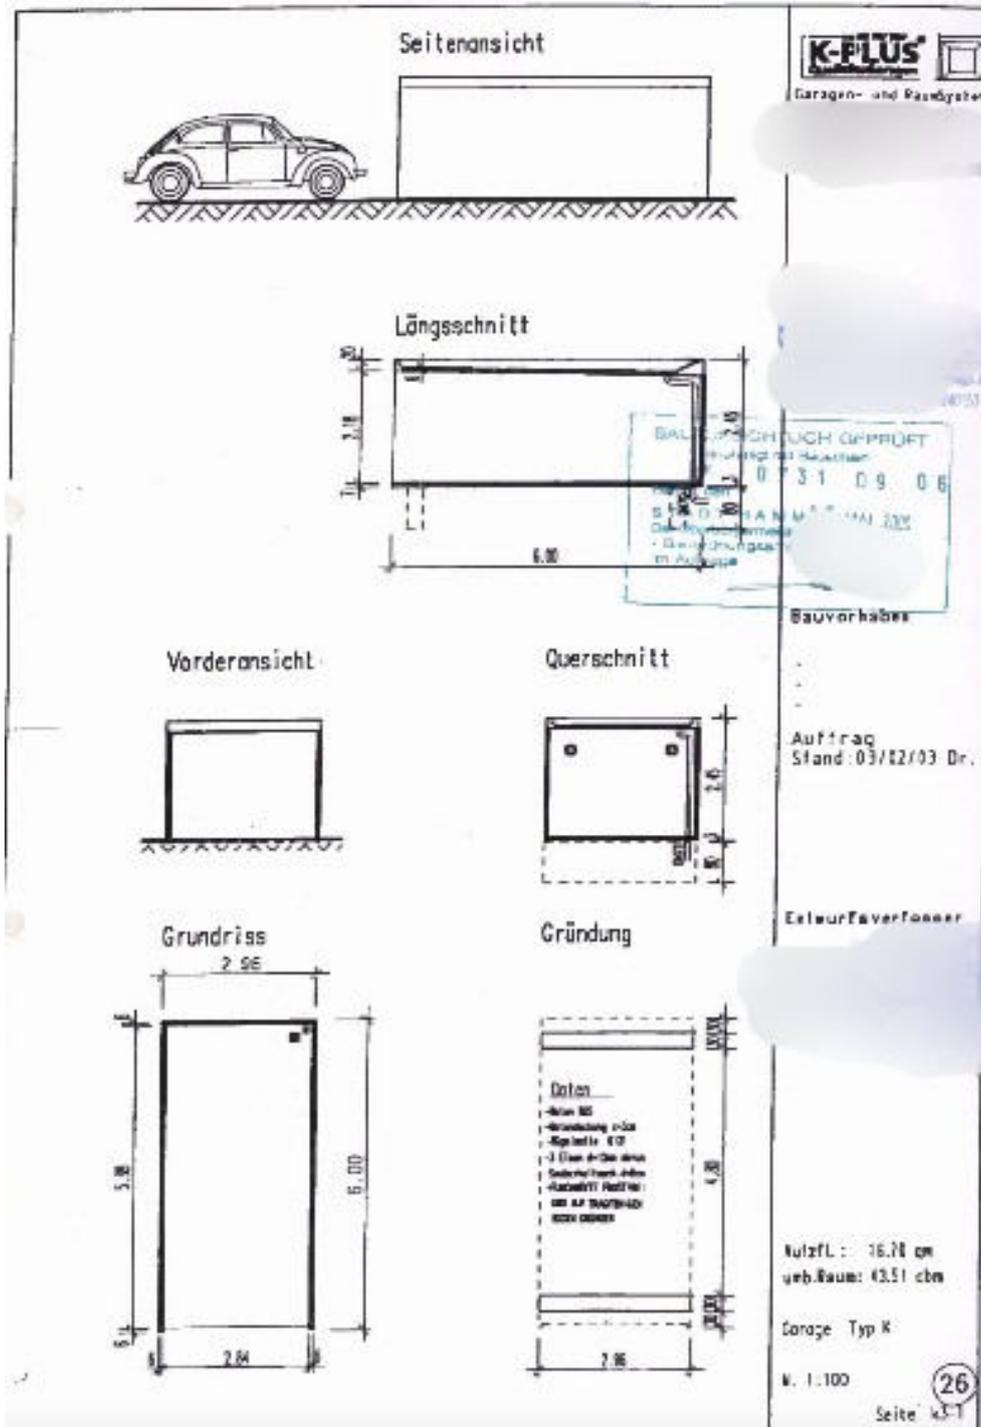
Grundriss, Ansichten, Schnitte Fertig-Garage
